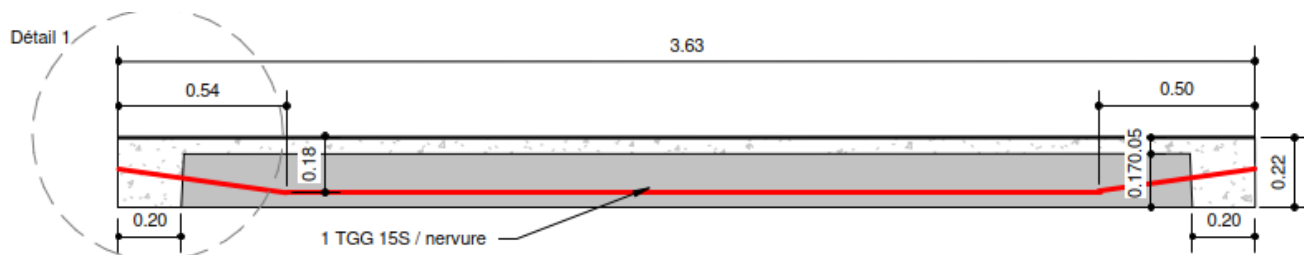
Coupe longitudinale d'un platelage de type 2 (sur clé) et tracé des câbles - Extrait du cahier de plans PRO
